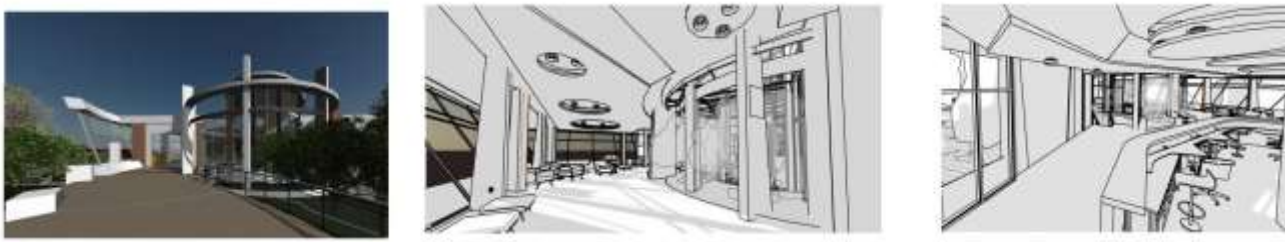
Vistas de la Planta Baja del Edificio Sede, exterior e interior.
